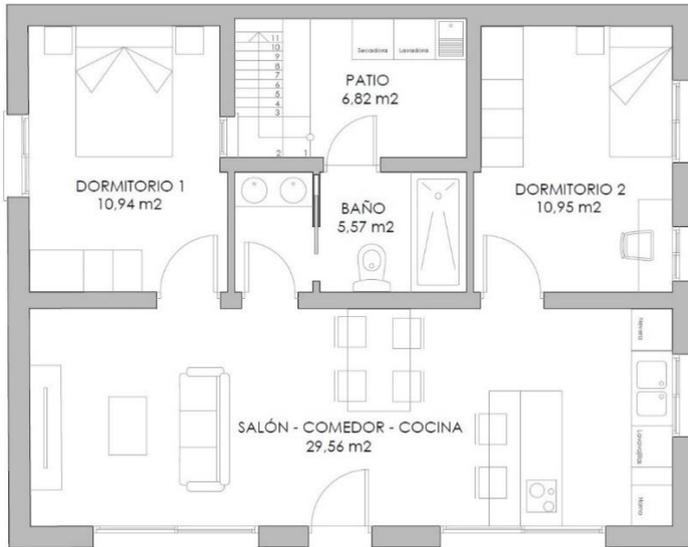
Planta distribución propuesta vivienda. 2022. Fuente Propia
